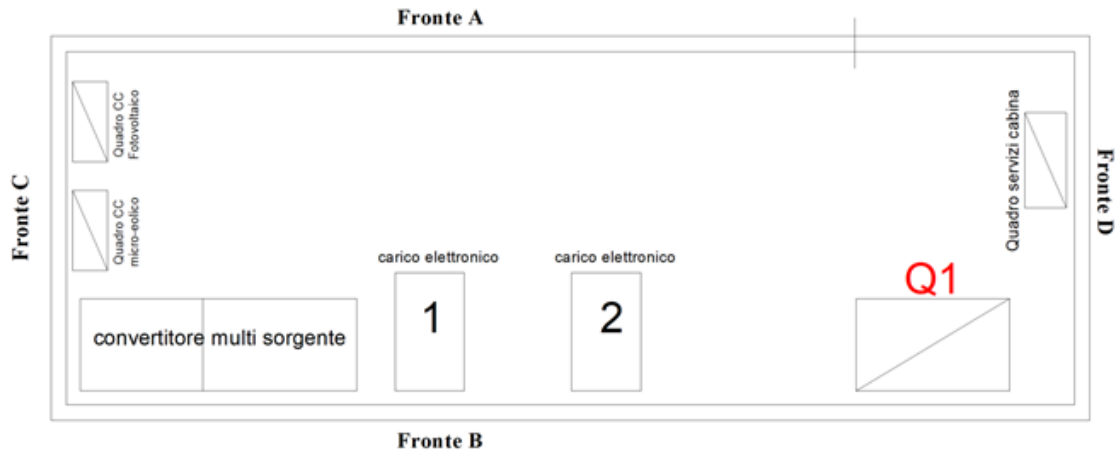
planimetria nuova cabina in progetto con indicazione della posizione dei nuovi componenti del sistema ibrido S.A.P.I.EN.T.E. - Soluzione B
